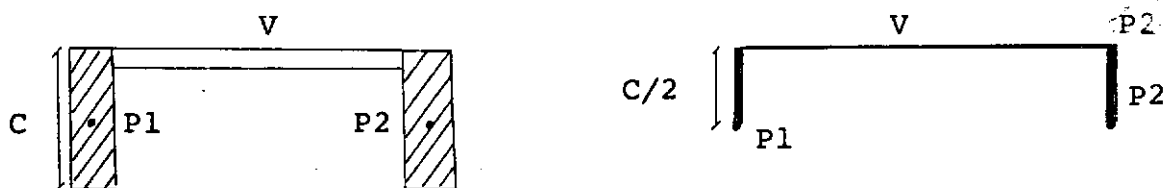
Idealização de viga excêntrica (vista em planta)
